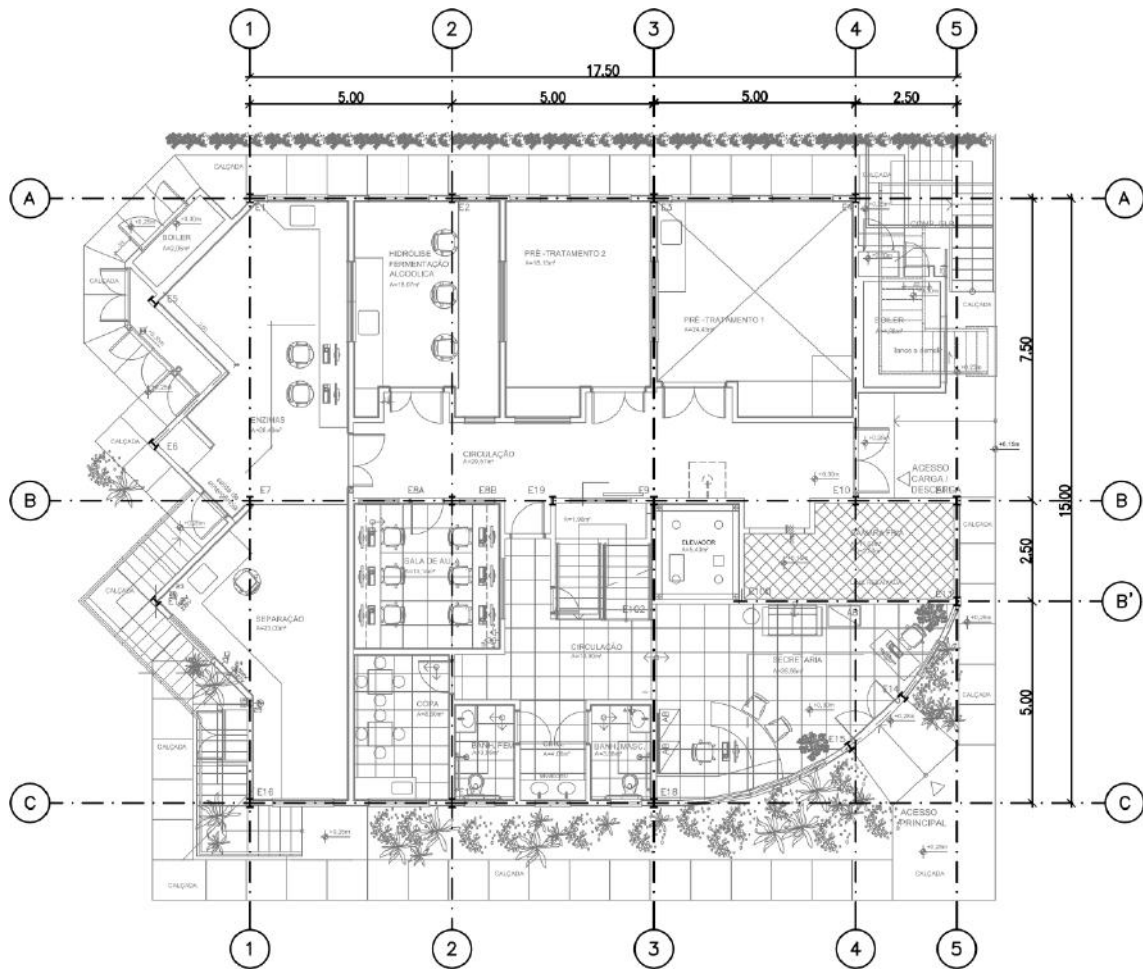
Geometria do Laboratório Bioetanol – Planta – Dimensões em metros
